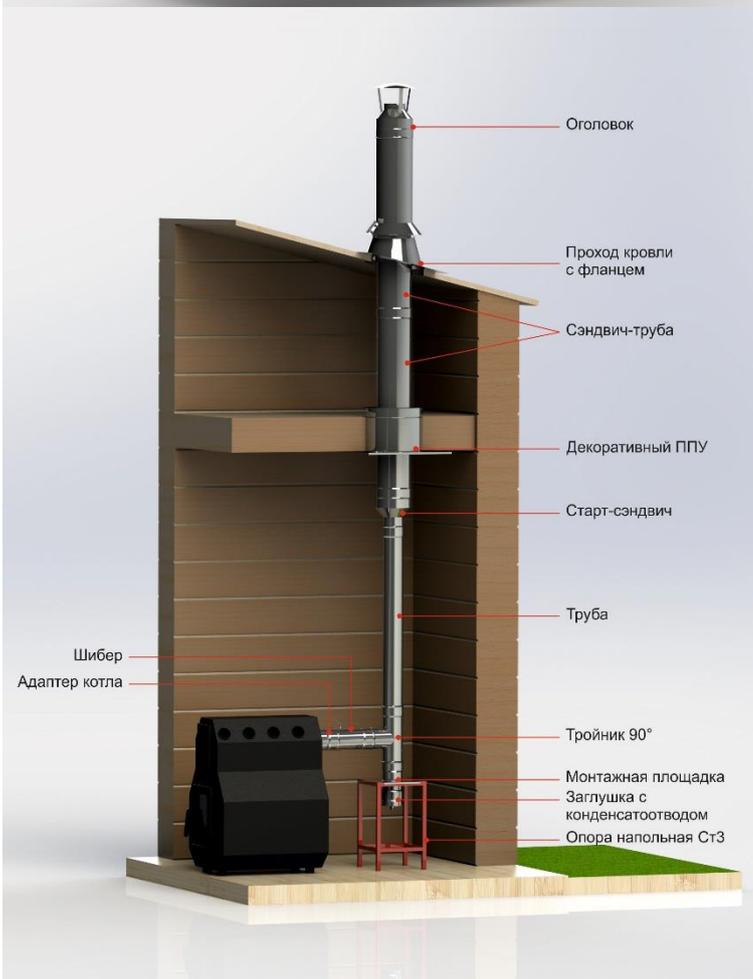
Двустенный вертикальный дымоход с проходом через потолочное перекрытие и кровлю, при горизонтальном выходном патрубке котла.
